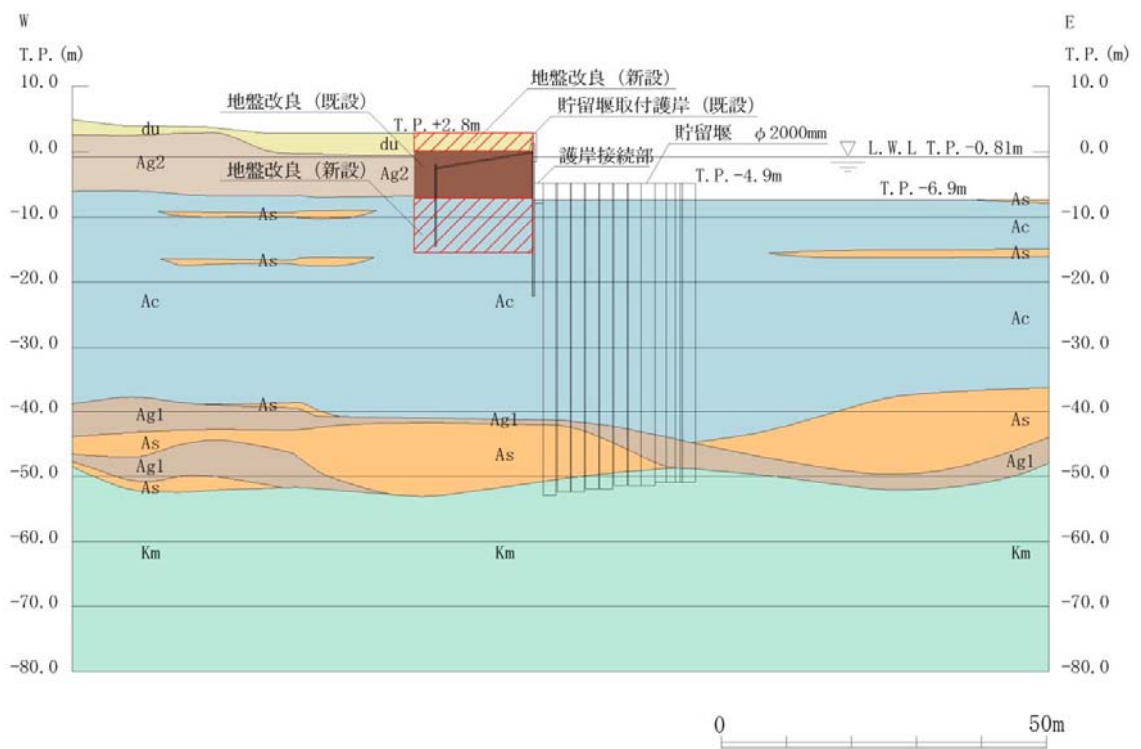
(1) 貯留堰の断面図 (EW-1)
